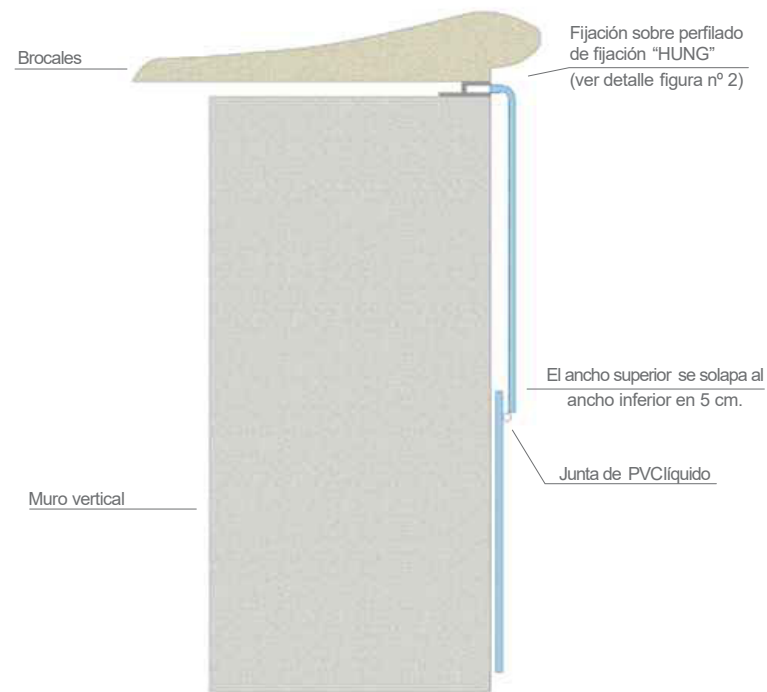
Soldadura de anchos verticales en una pared plana
